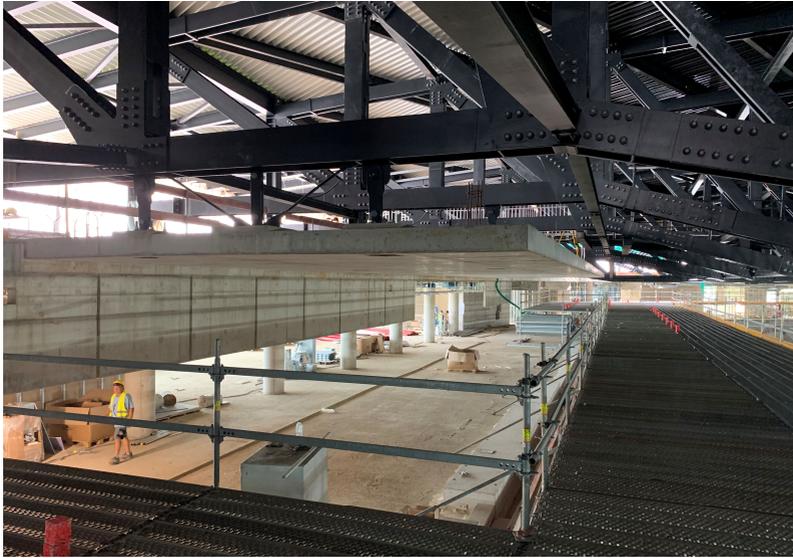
abgehängte Stahlbetonplatten im Dachtragwerk der Bowl
